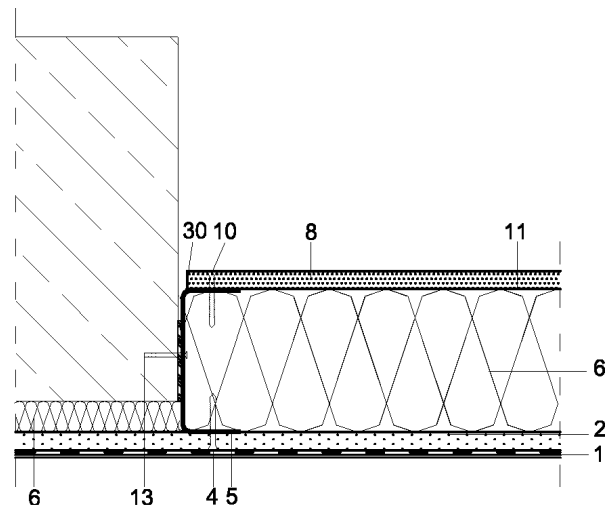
Encuentro con pilar del sistema de hoja simple.
